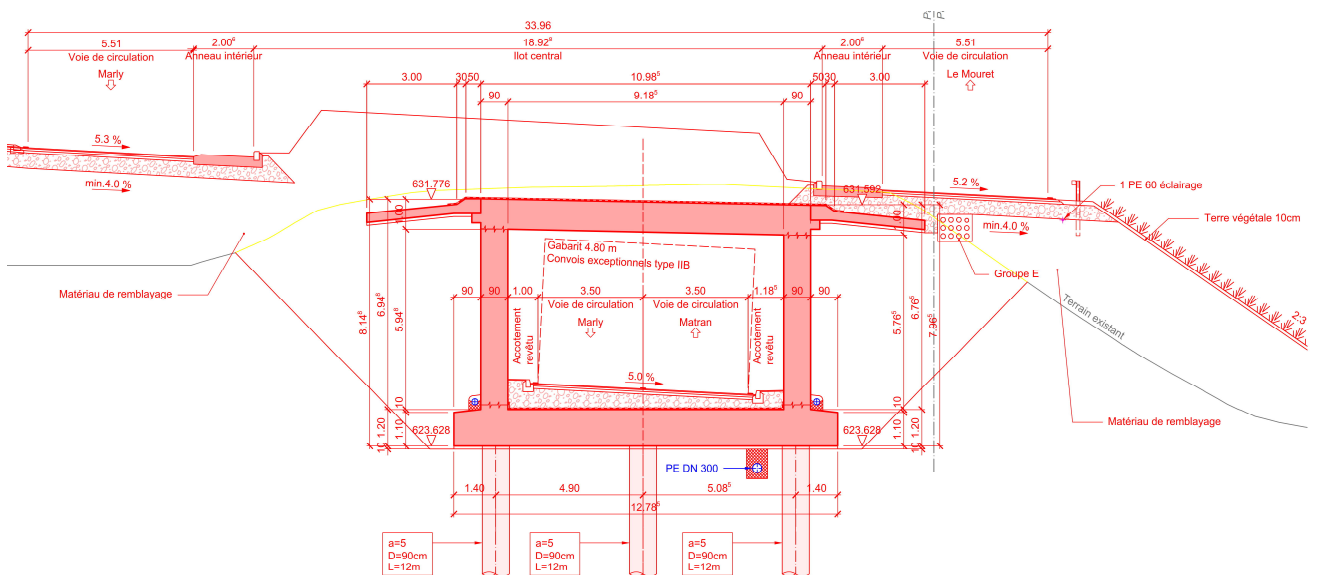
Coupe transversale du PI Crausa, zone PI, km -0+020
